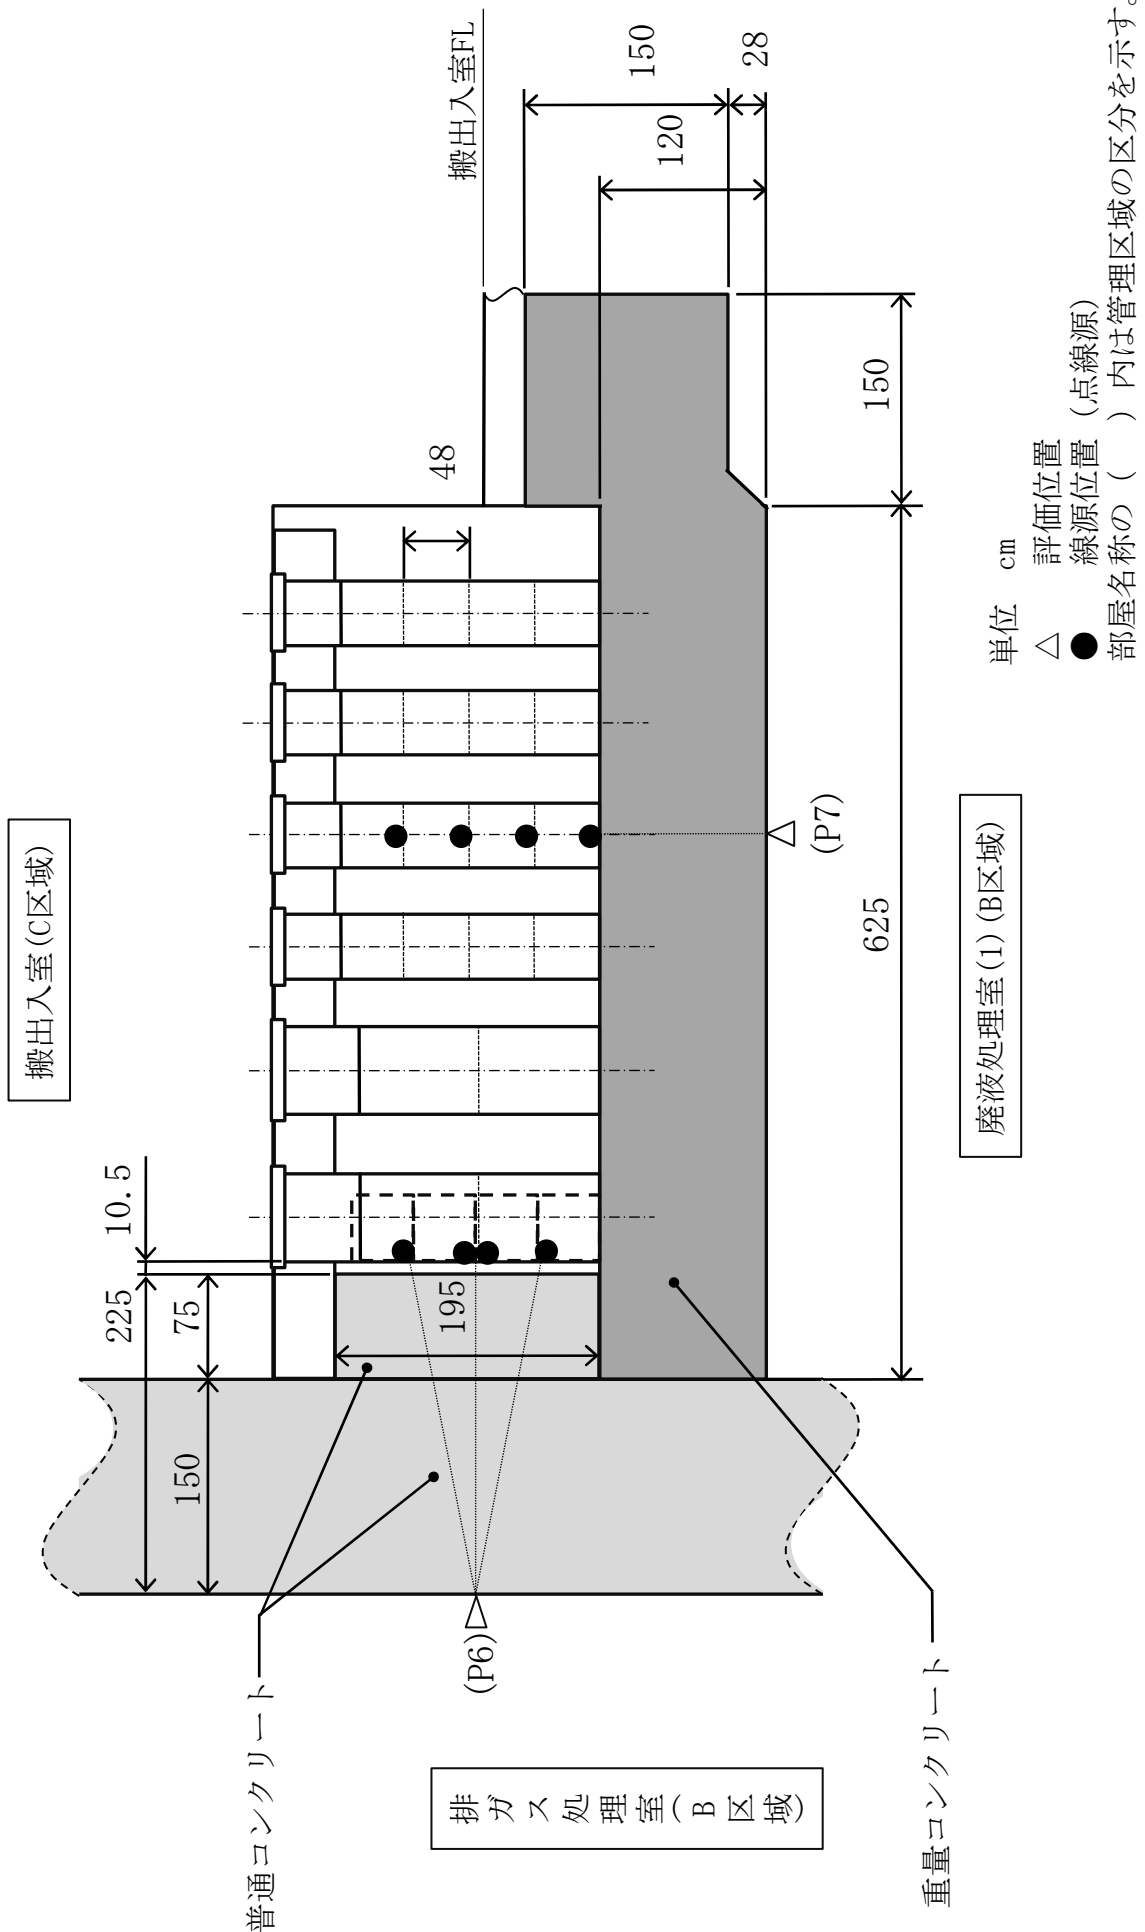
(3) 搬出入室 (廃棄物搬出入ピット) の線量率評価位置図 (断面図)
